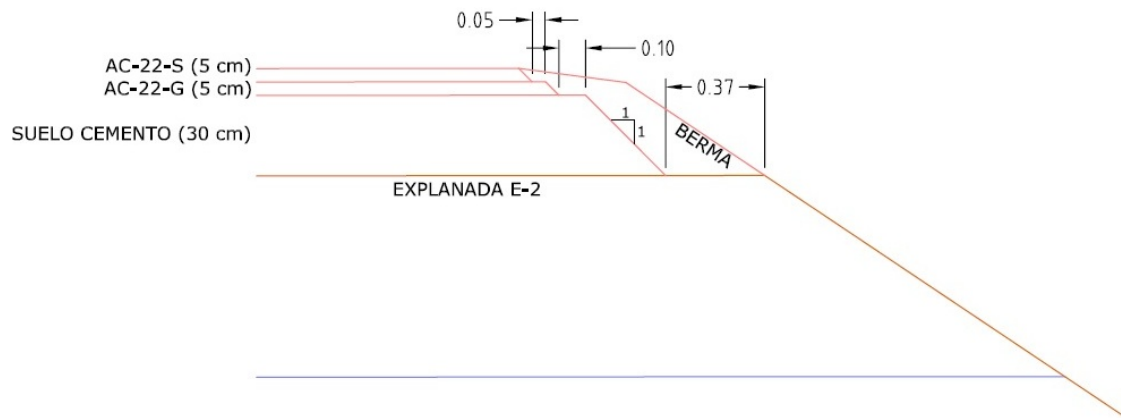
Sección Tipo. Corte Transversal de Firme.
